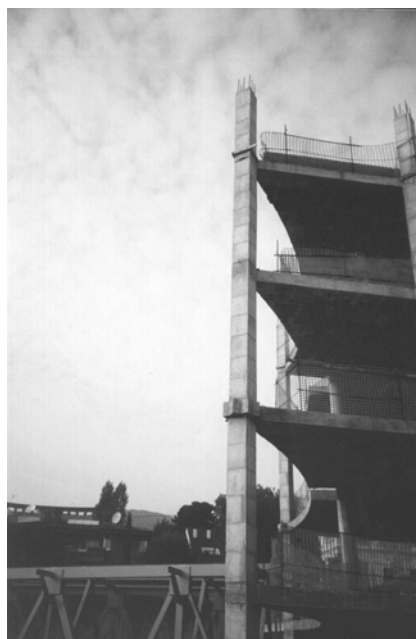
Edificio con nudos excesivamente débiles por la defectuosa colocación de los pilares.
